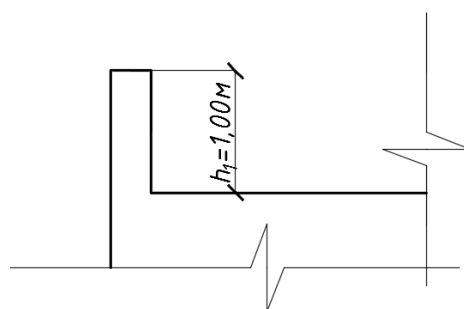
К расчету снеговой нагрузки в зоне парапетов
